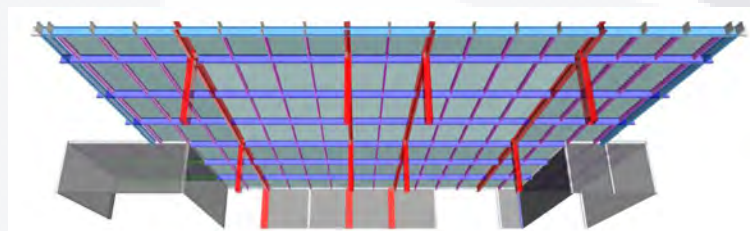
Perspectiva inferior de modelo con elementos tipo Deck. Fuente: Elaboración Propia
